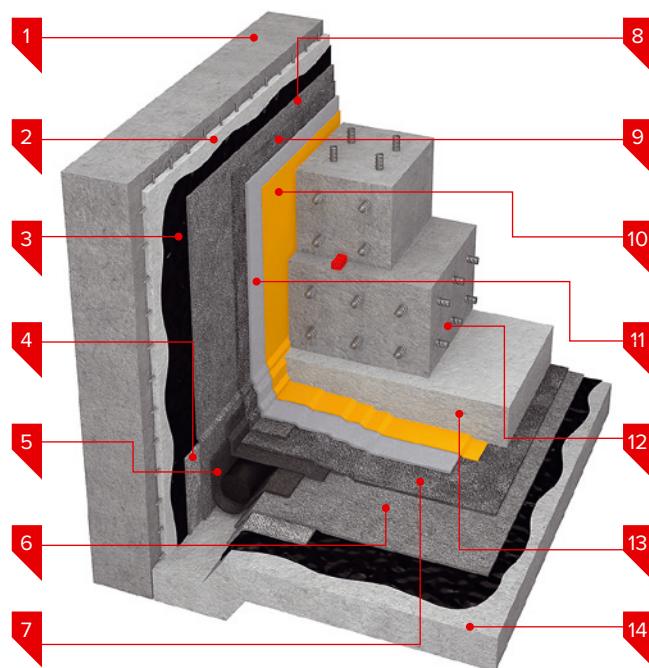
Техноэласт Фундамент. Зона подошвы фундамента. Вариант со сплошной приклейкой к основанию:
